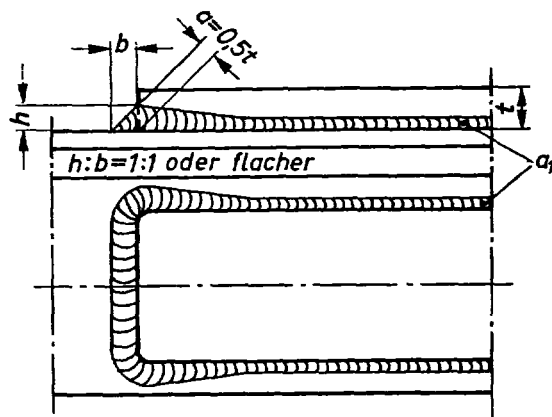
Ausbildung der Schweißnähte an Gurtplattenenden
